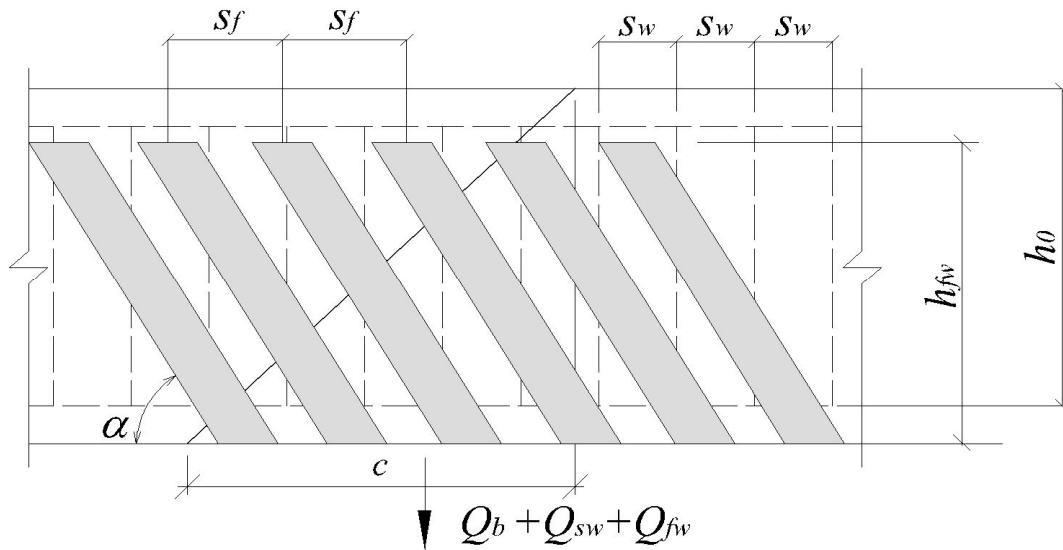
Схема усилий при расчете железобетонных элементов с внешним армированием из композитных материалов по наклонному сечению на действие поперечных сил.
